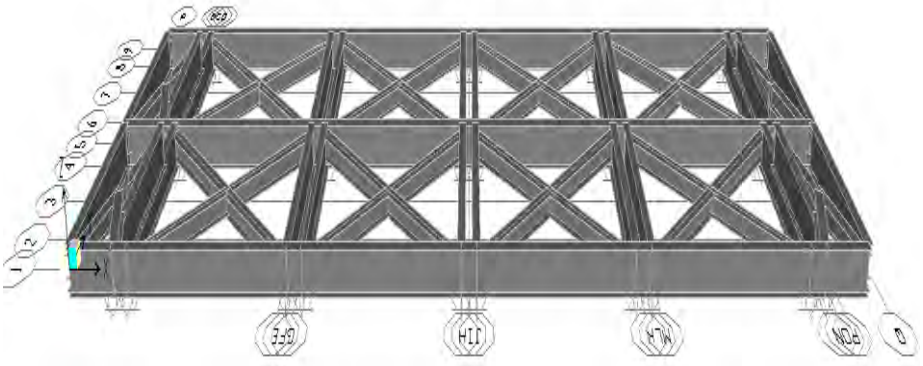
Denah Keelblock di Satu Segmen Cradle
